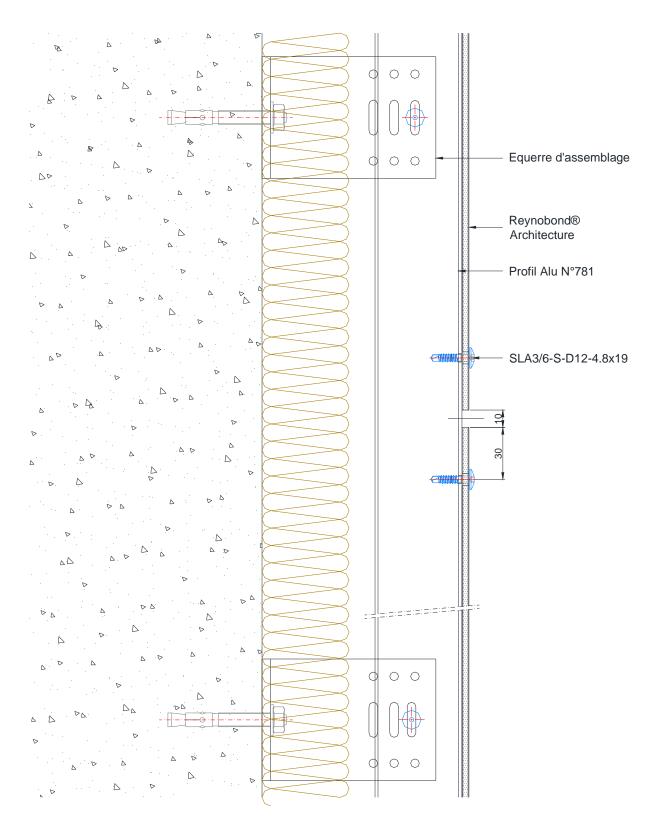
is – Joint horizontal - Coupe verticale – Système vissé SC 50 2c
